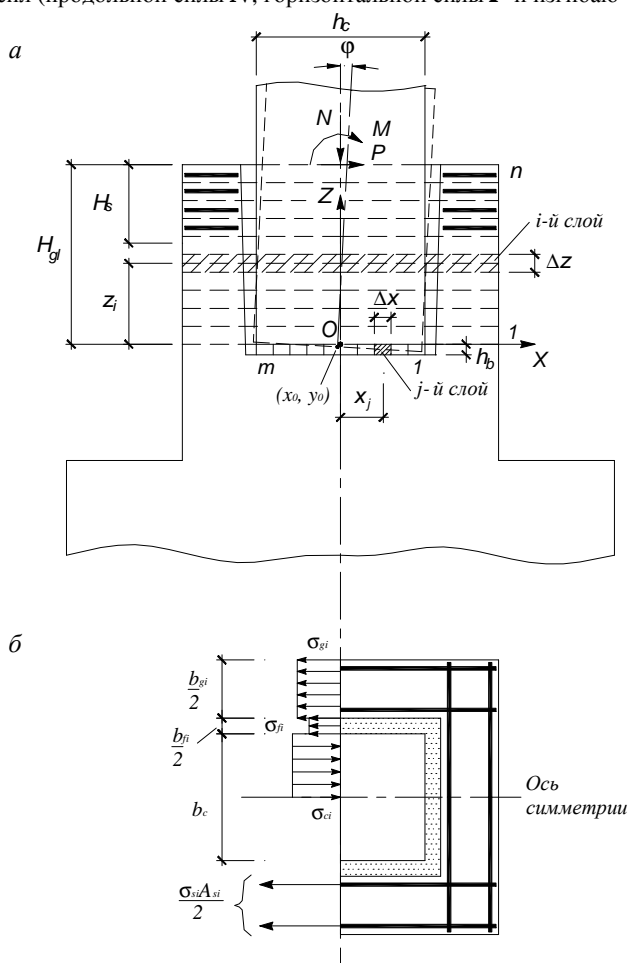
К расчету стыка железобетонной колонны и фундамента
